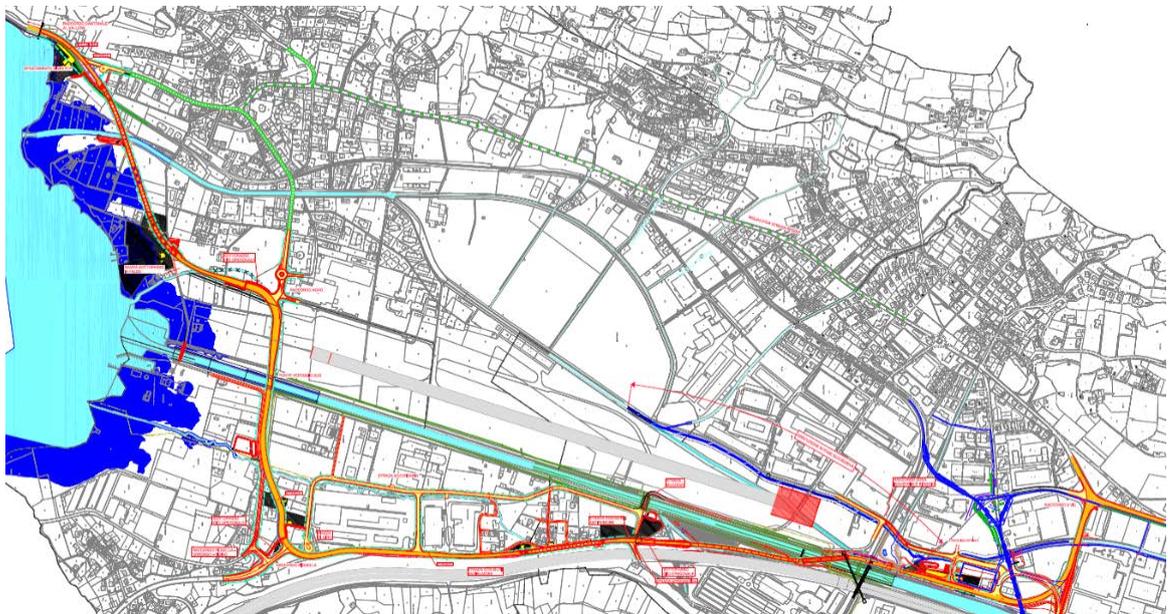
Planimetria della circonvallazione (stato Progetto definitivo 2015)
